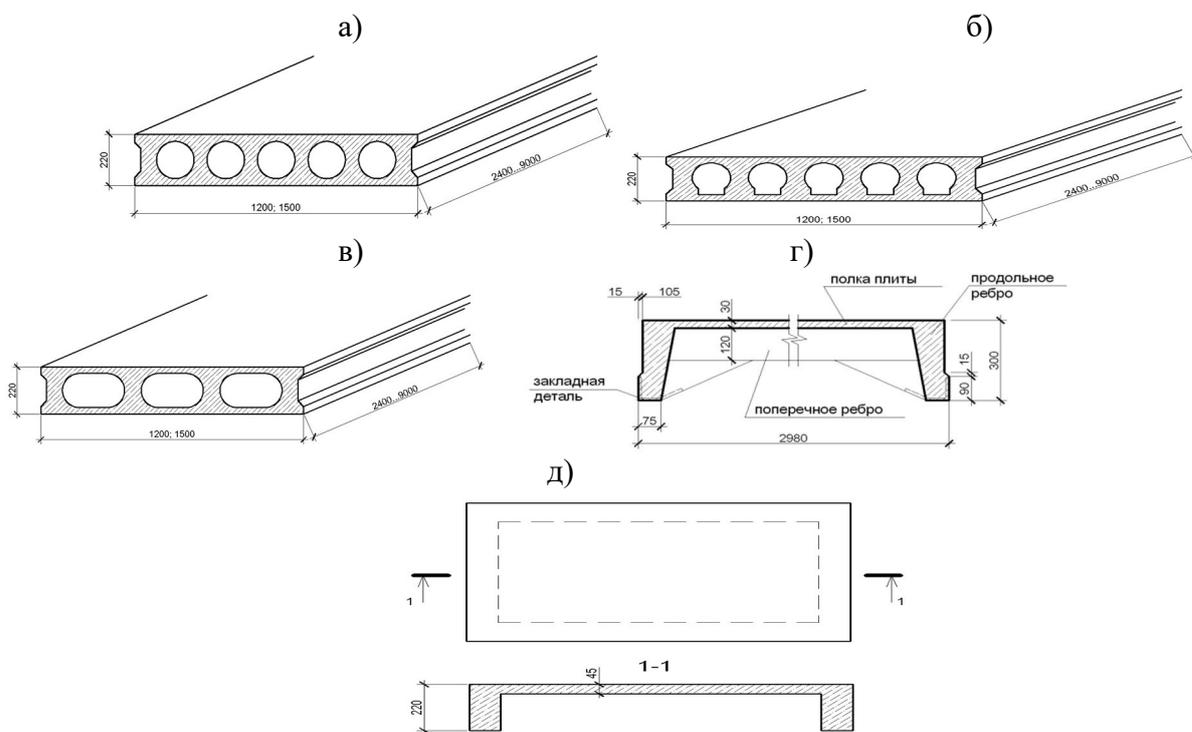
Многупустотные и ребристые плиты перекрытий: а- с круглыми пустотами, б – с вертикальными пустотами, в – с овальными пустотами, г – ребристые, д – шатровые
